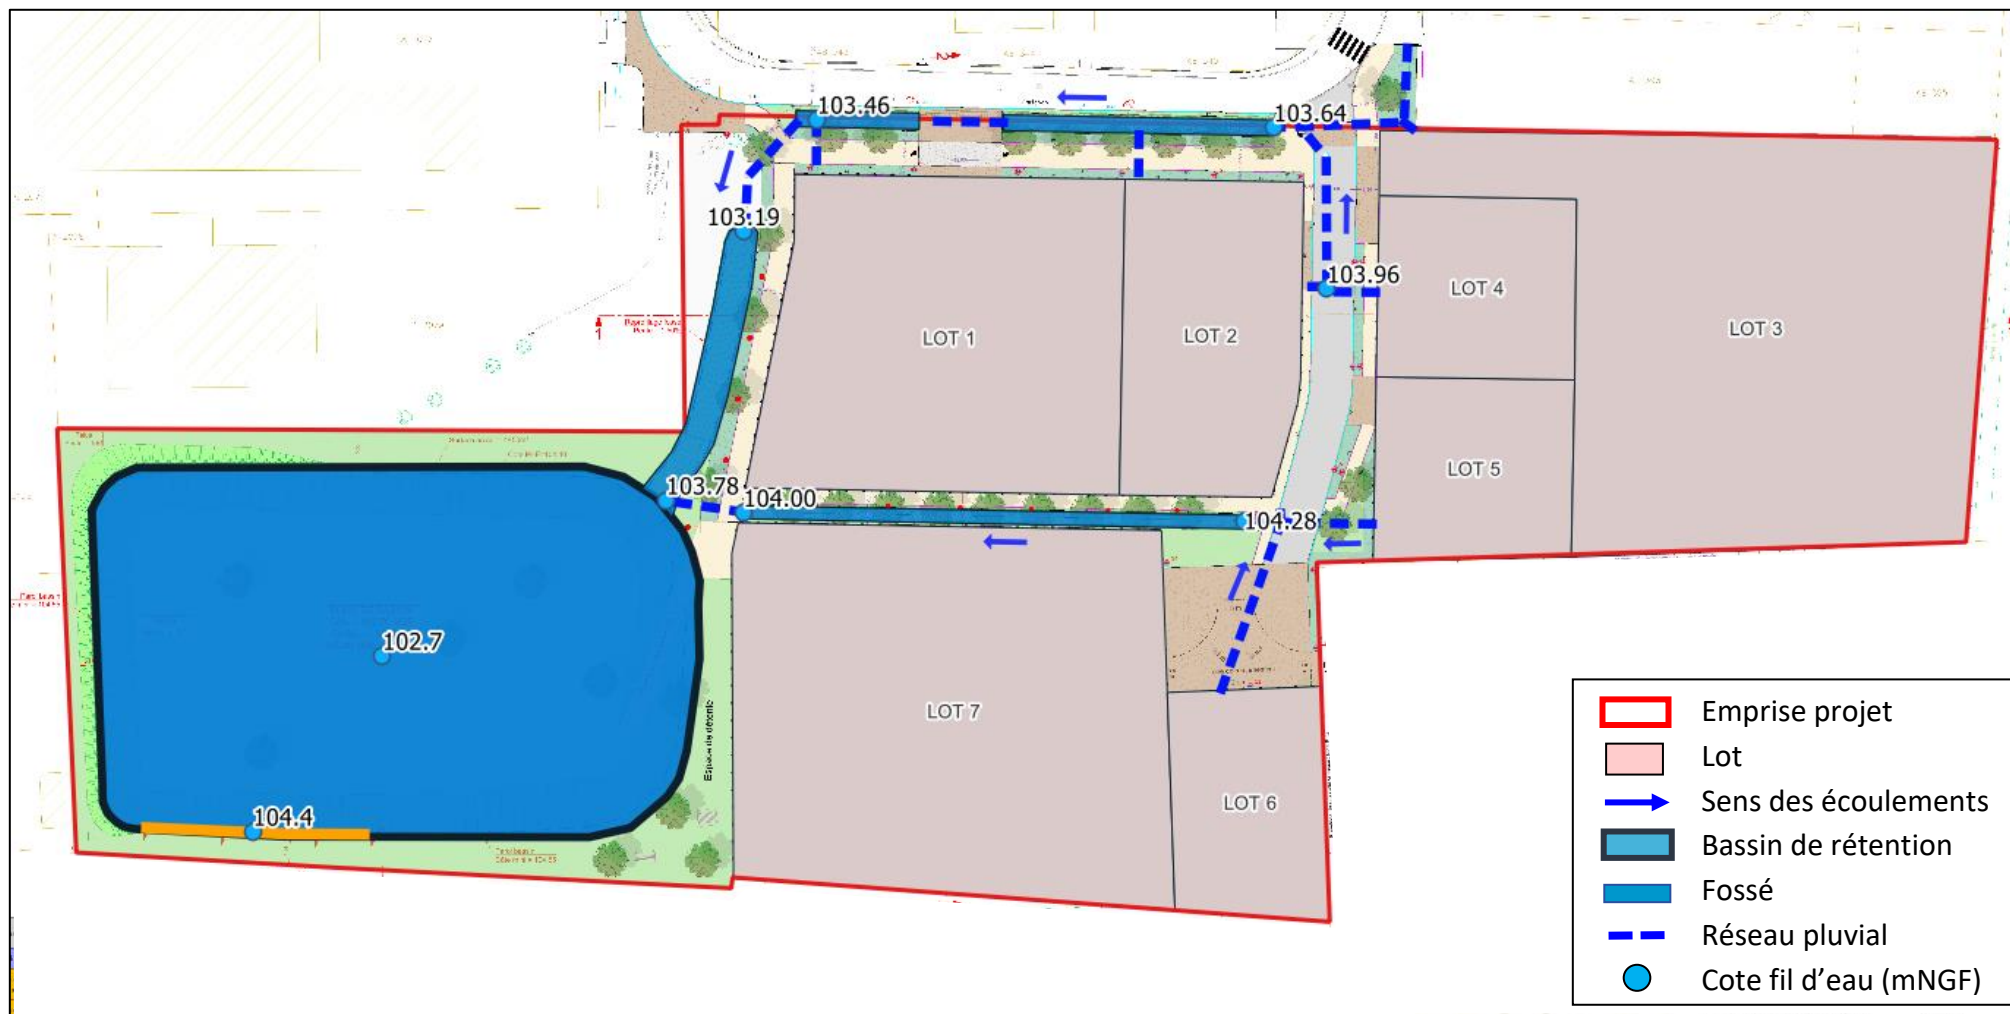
Plan de principe général de gestion des eaux pluviales du projet
